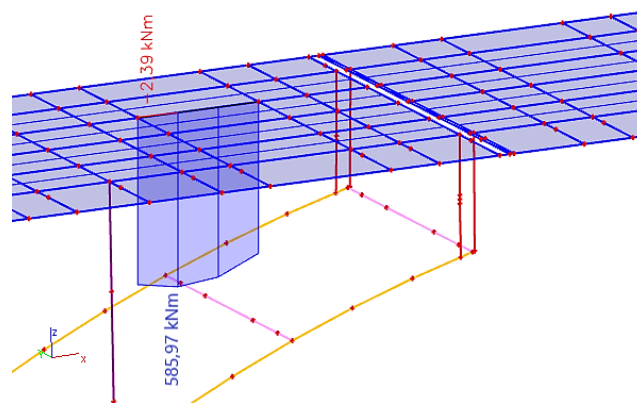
Příčné roznášení zatížení od dvounáprav umístěných u levého obrubníku
